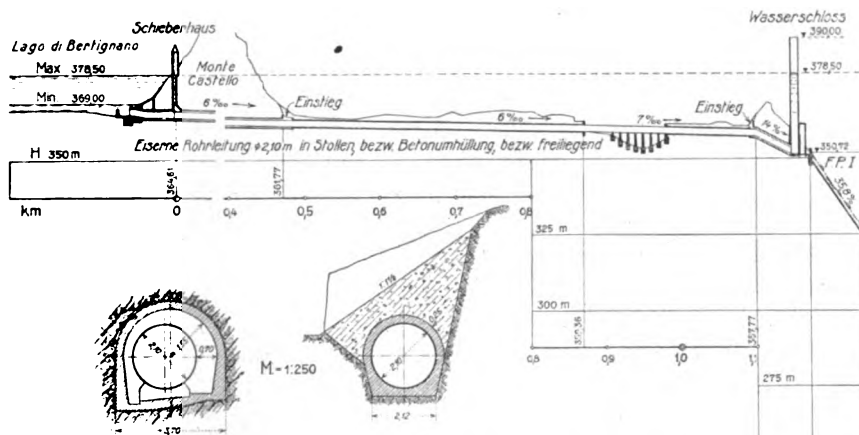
Längenprofil der Druckleitung. — Längen 1:10000, Höhen 1:2500. Querprofile des Druckstollens, 1:250.
